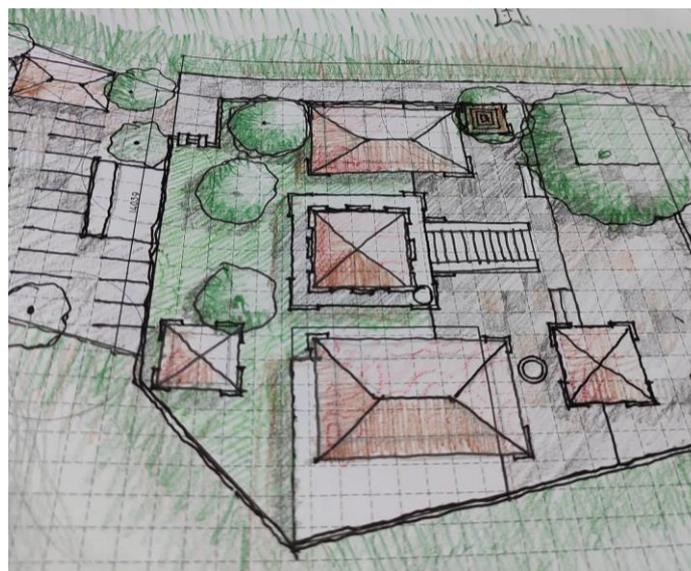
Gambar Layoutplan Eksisting di Pura Bungli
